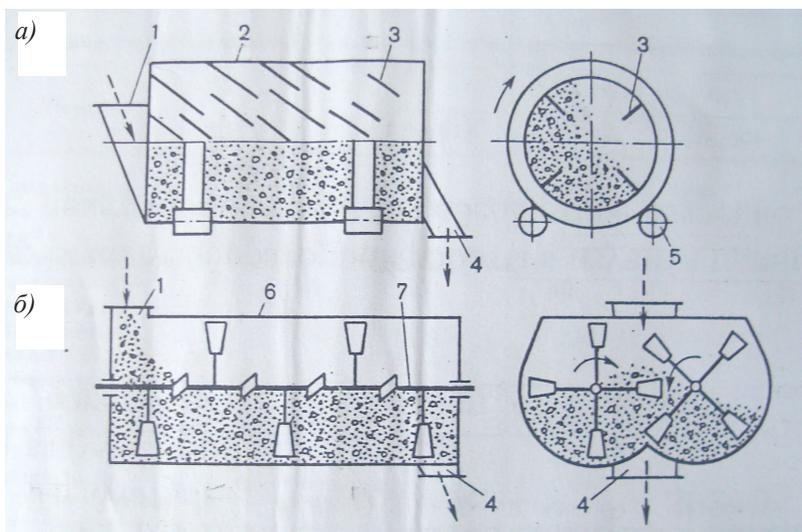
Принципиальные схемы смесителей непрерывного действия: а – гравитационного действия; б – принудительного действия; 1 – загрузочное отверстие; 2 – барабан; 3 – лопасти; 4 – разгрузочное отверстие; 5 – опорные ролики; 6 – корпус; 7 – лопастной вал
